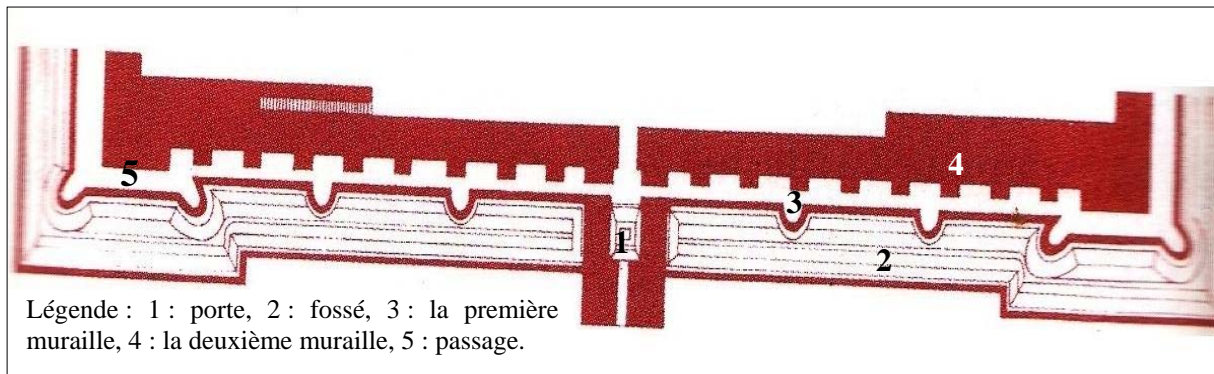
Reconstitution du plan de la forteresse haute de MIRGISSA, Egypte.
